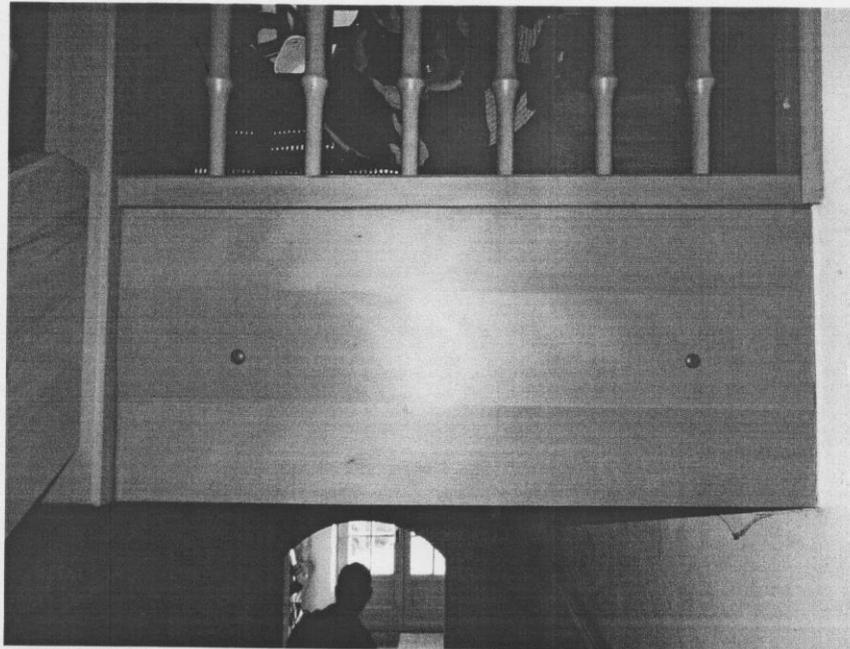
wie Bild 22, Geschossdeckenverkleidung
